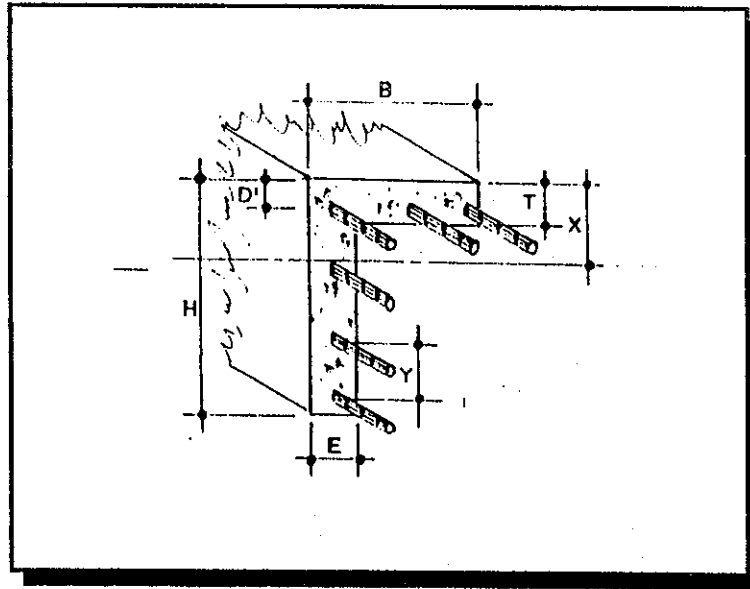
VIGA DE SECCION "L". SOMETIDA A ESFUERZO DE FLEXION.
